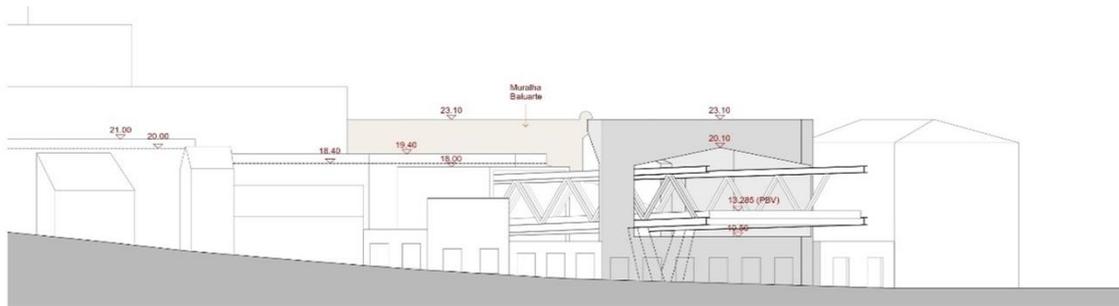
Alçado edifício e fachadas a reconstruir (ML 122112).
